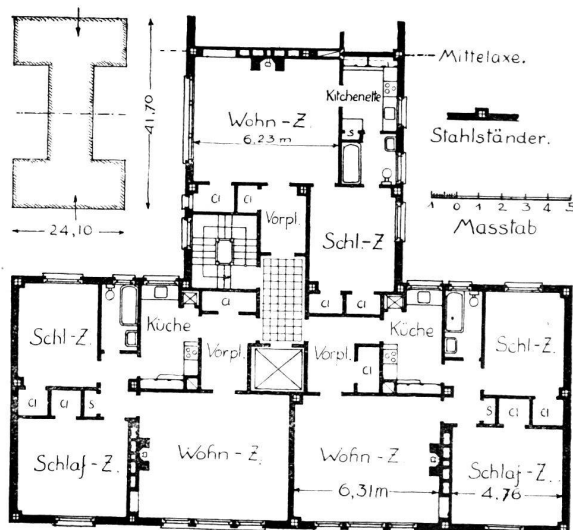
Plan d'une maison locative à New-York, 12 étages. A chaque étage, 6 appartements de 2 à 3 pièces (cuisine non comprise). Construction en acier avec parois en briques. A gauche en haut, plan du bâtiment complet — cl. - closet, c'est à dire armoire profonde, sorte de penderie. Wohnz. - chambre commune, Schlafzimmer - chambre de coucher, Vörpl. - Vestibule.
